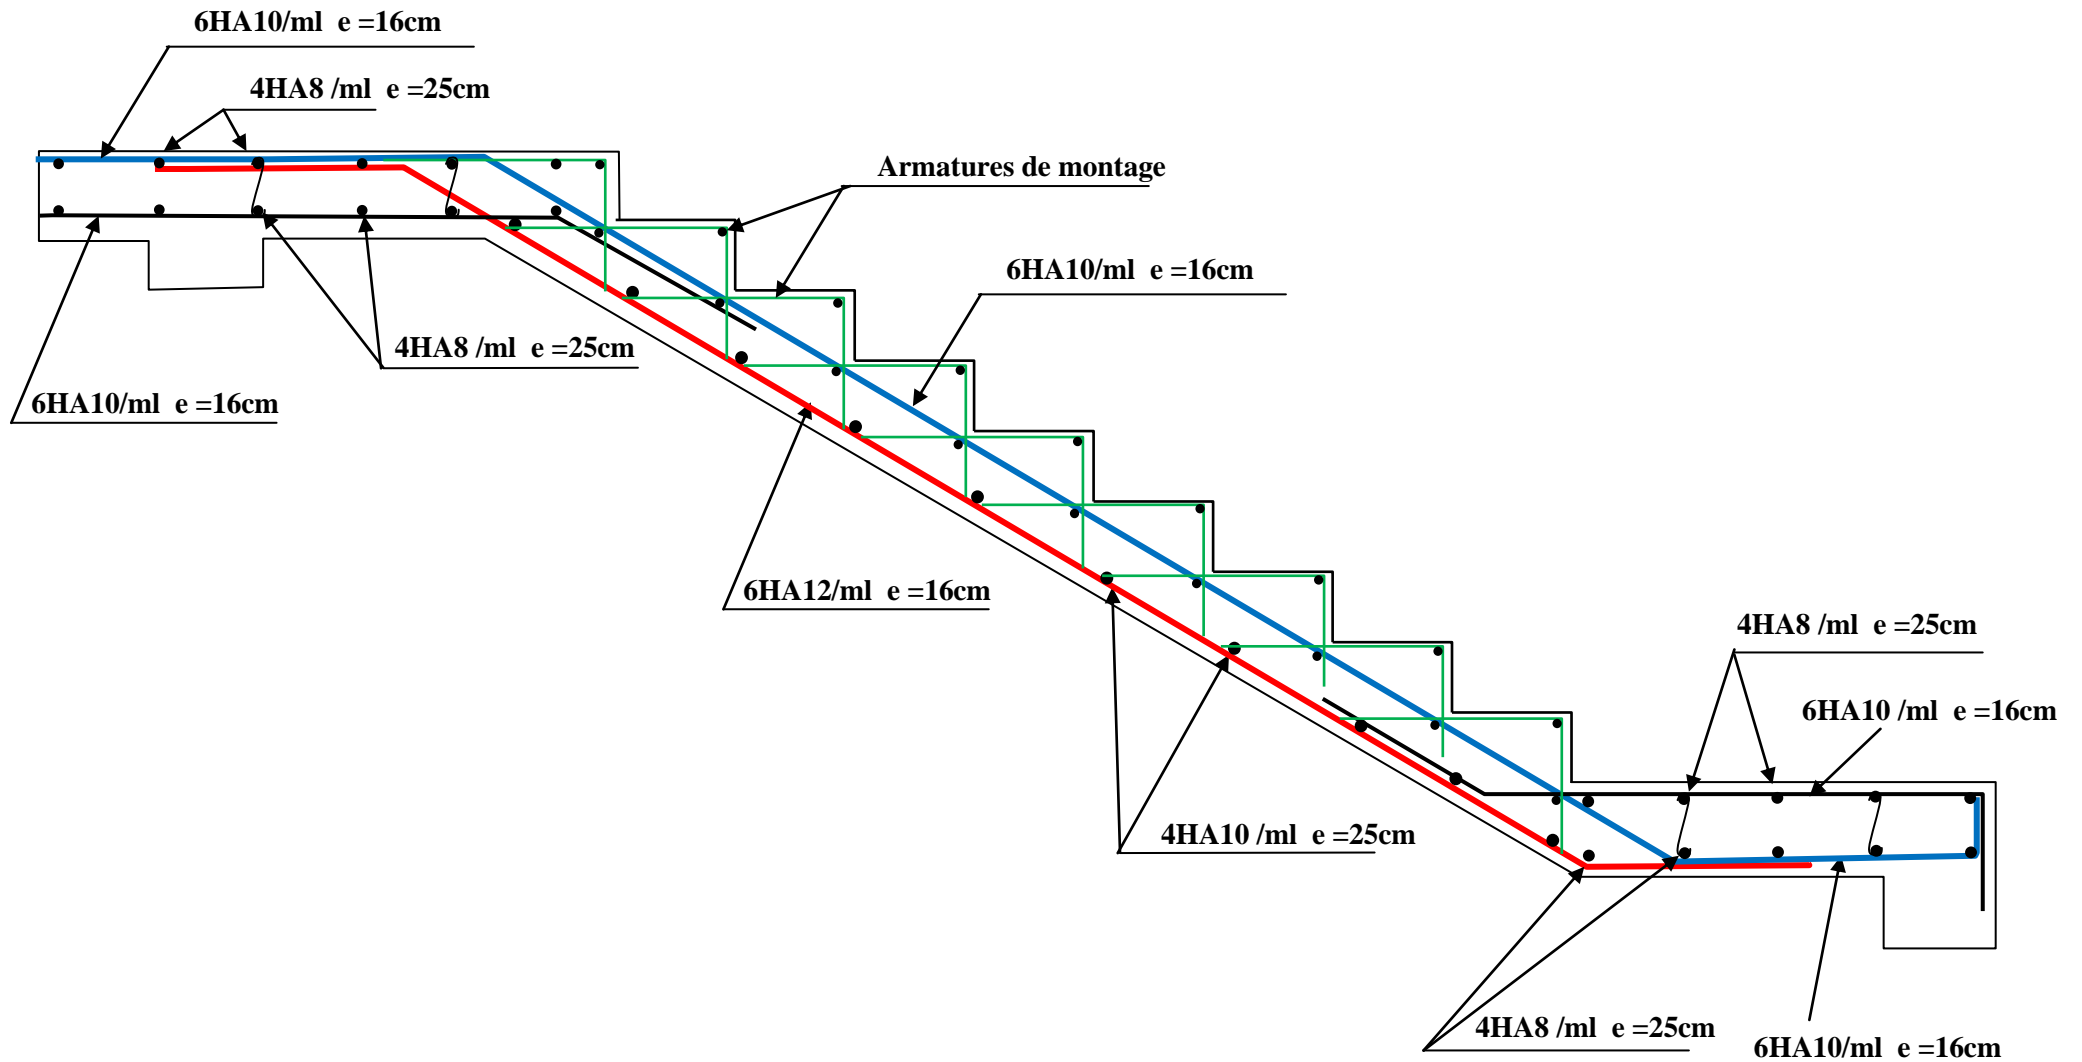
FERRAILLAGE DE L'ESCALIER DROIT
